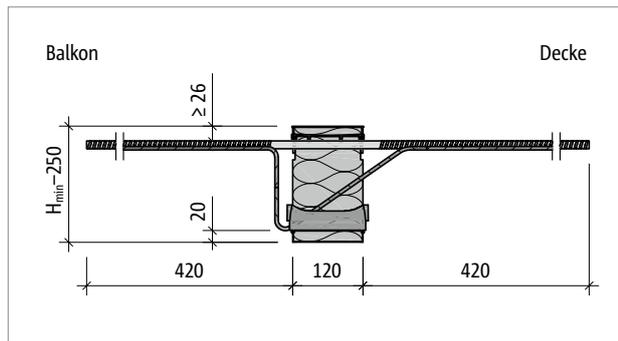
Schöck Isokorb® CXT Typ K-M6 bei R0: Produktschnitt
